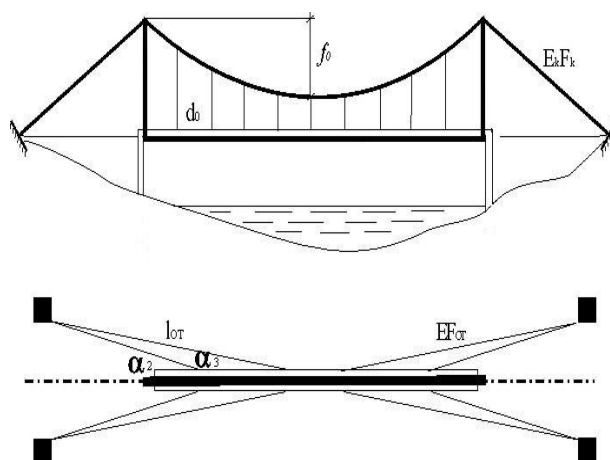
Схема цепного висячего трубопровода с одной фермой
